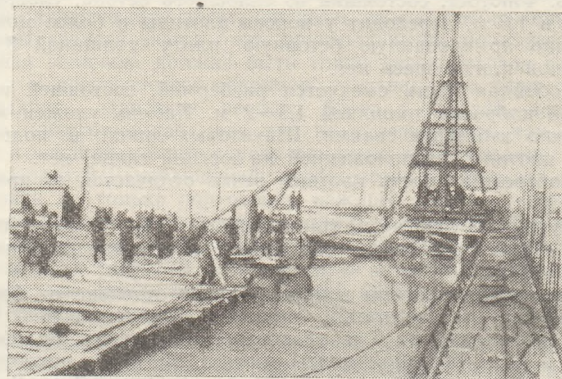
Бетонирование гребня забитого шпунта. Бадья с бетоном подается водолазу
